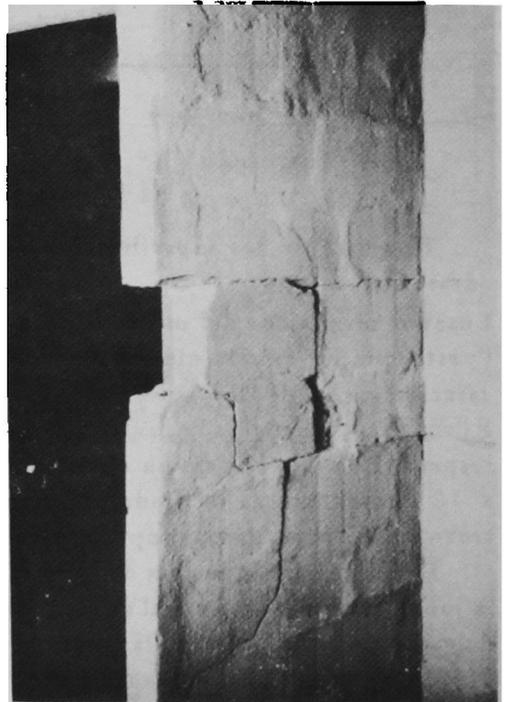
Detalle de grietas entre bloques de un tabique interior. Población Pedro Aguirre Cerda.
